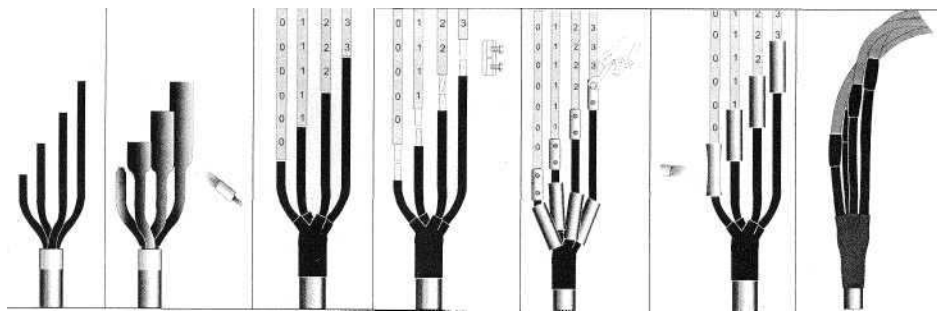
Монтажные операции перехода от кабельной линии к СИП
